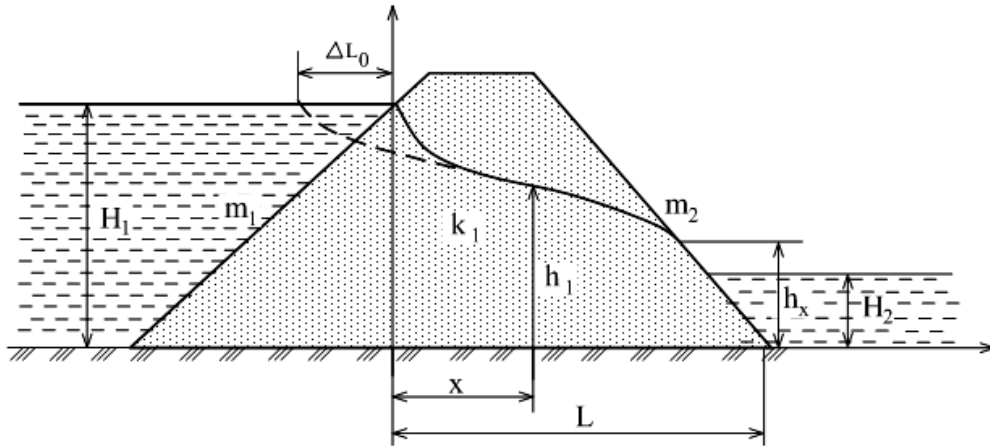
Расчетная схема земляной однородной плотины без дренажа (или с наклонным дренажом)
